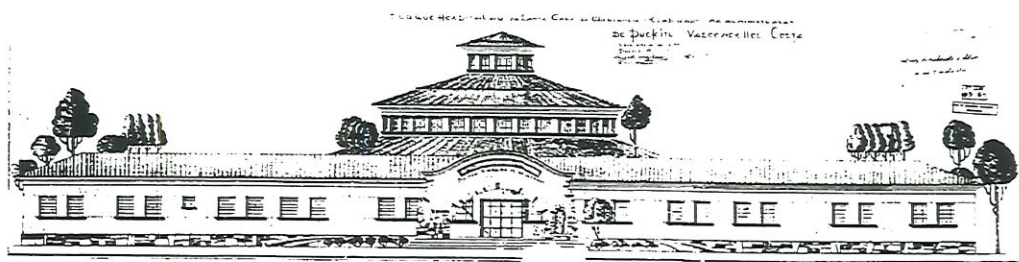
Parque Hospitalar Santa Casa – 1948 - Fachada
